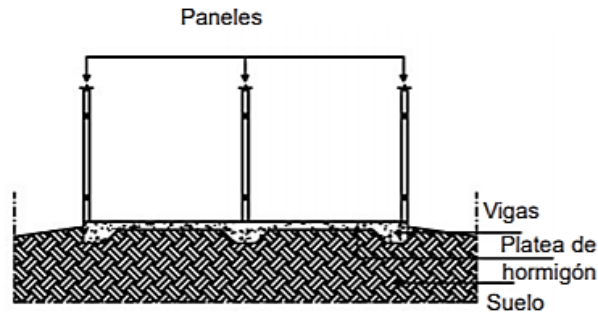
Losa de cimentación, Steel Frame
